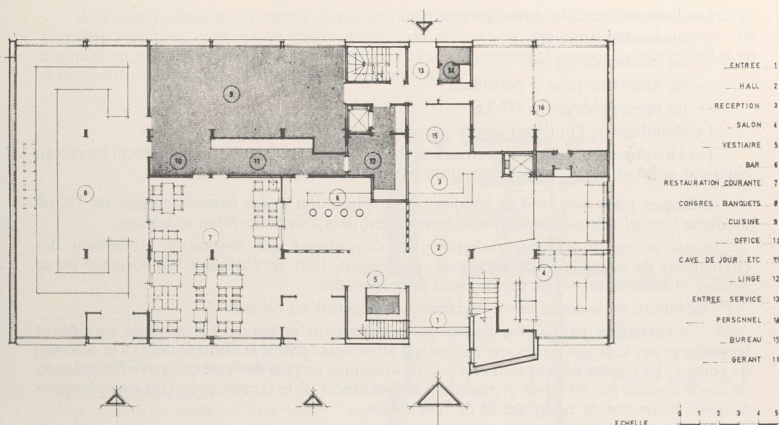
Plan rez-de-chaussée. Cas d'une restauration développée.
